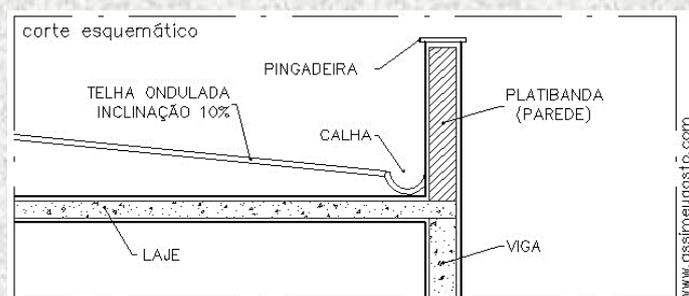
Detalhamento instalação telhado com telha de fibrocimento.
